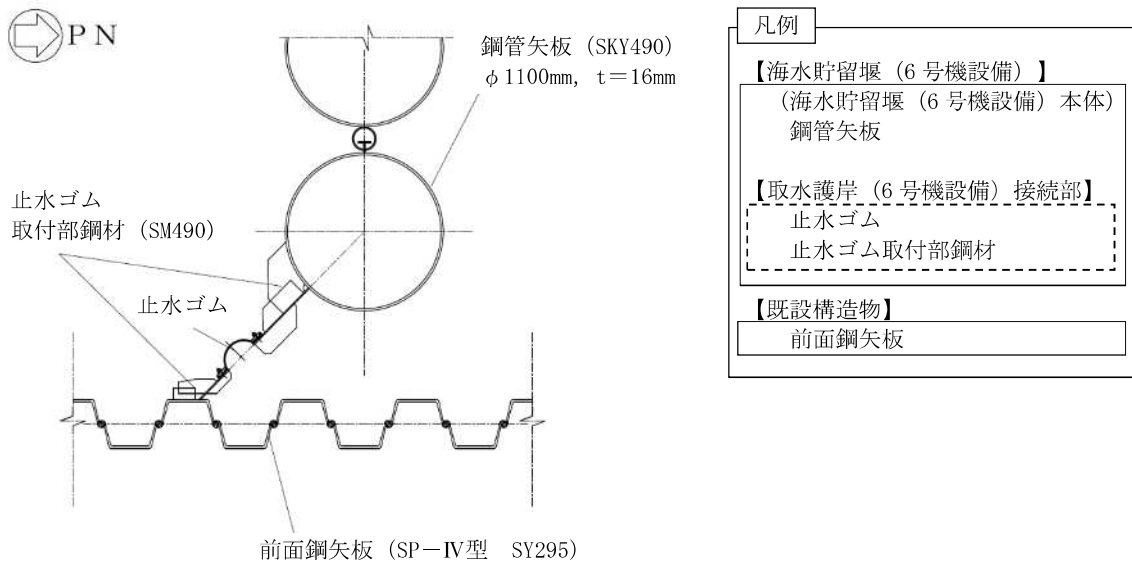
(2) 海水貯留堰 (6号機設備) の平面図 (A部拡大)
